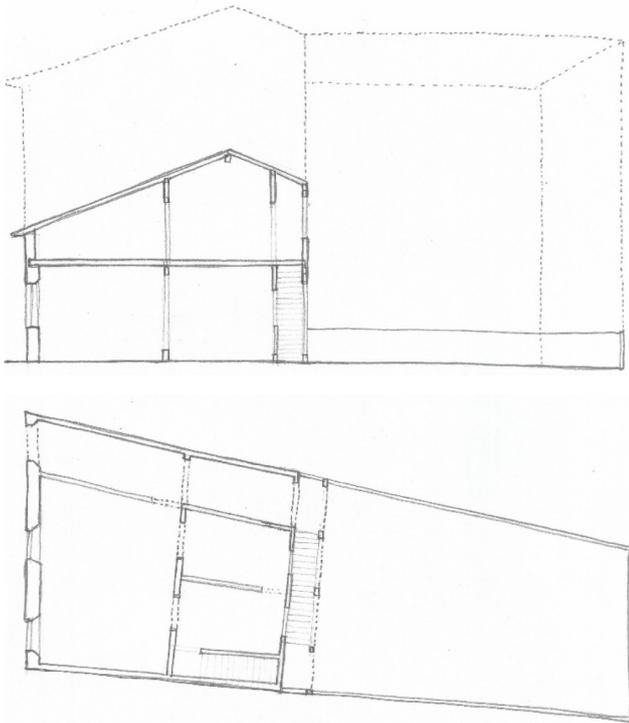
Reconstrucción de la 'Casa a la malicia' existente en c/ Jardines (1759): planta baja y sección. (E. González-Redondo).
